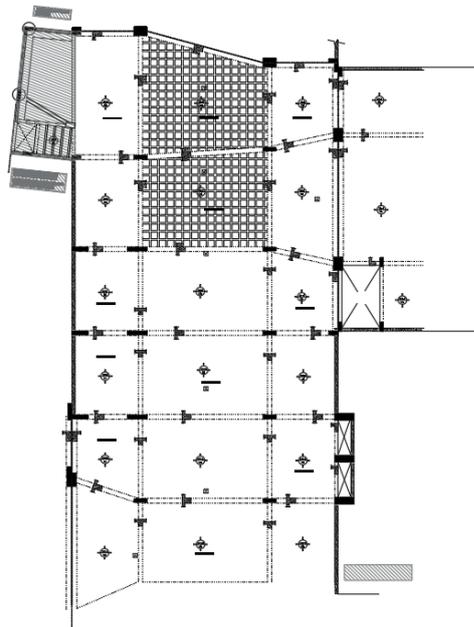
Planta de estructuras correspondiente a la Planta sobre segundo subsuelo.
